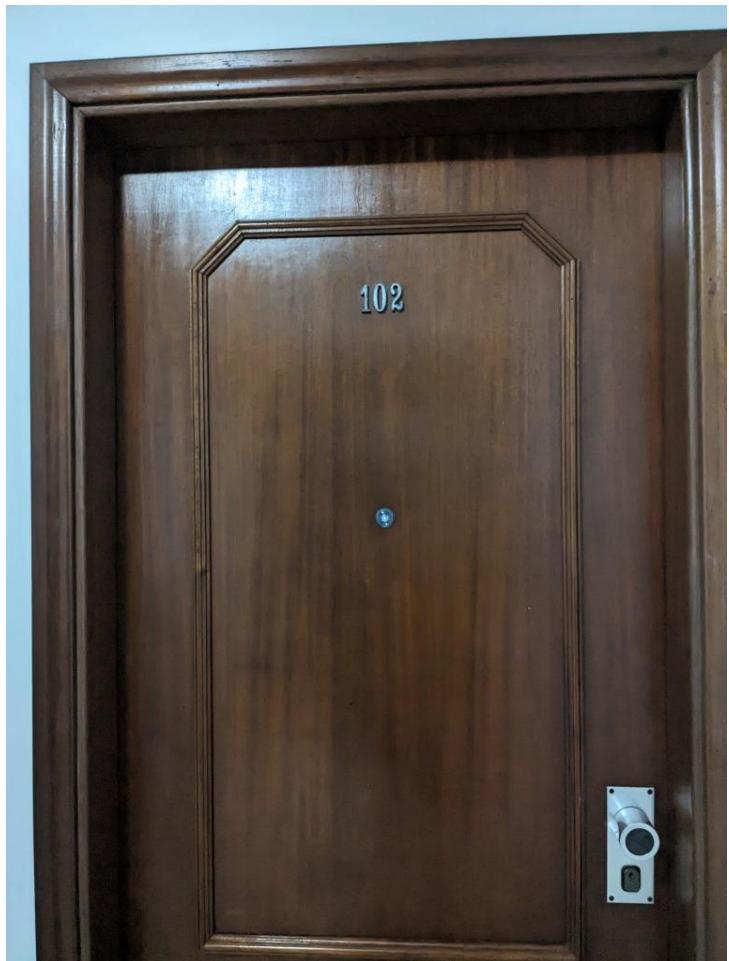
Porta de entrada da unidade avalianda – nº 102 no 12º andar
